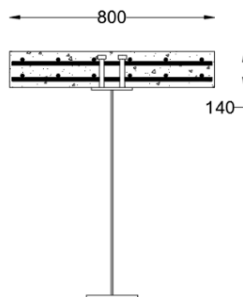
Secção tipo das vigas do ensaio MI 4
